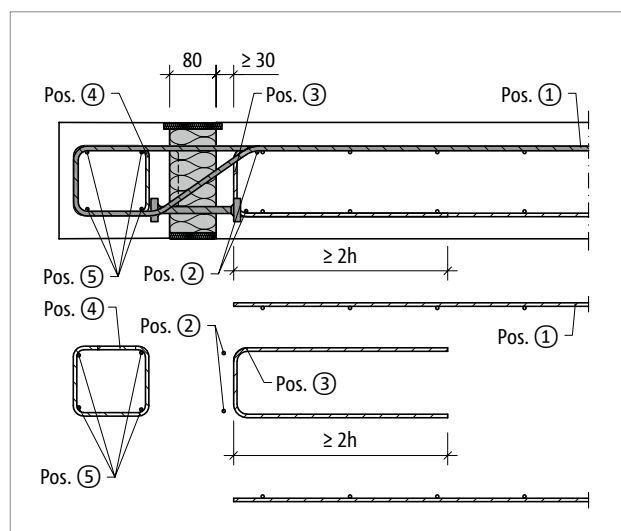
Schöck Isokorb® T type O : Renforcement sur site
